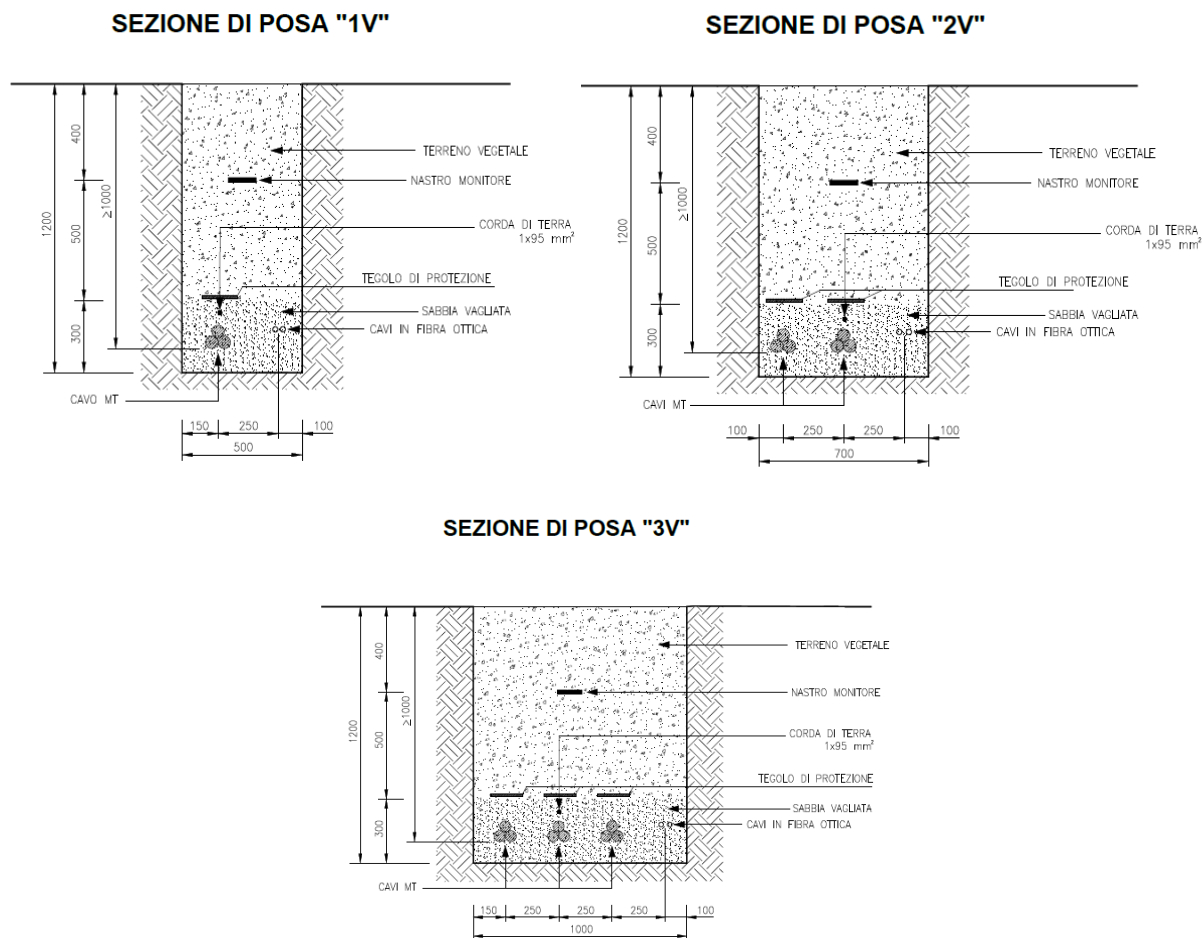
Sezione di posa cavidotti su terreno vegetale
